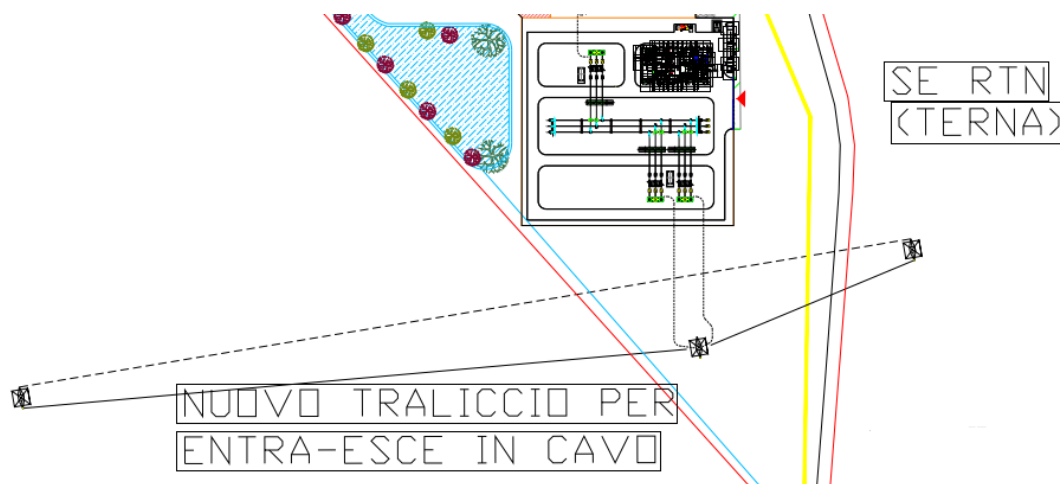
Layout del nuovo collegamento in entra esce della stazione TERNA
